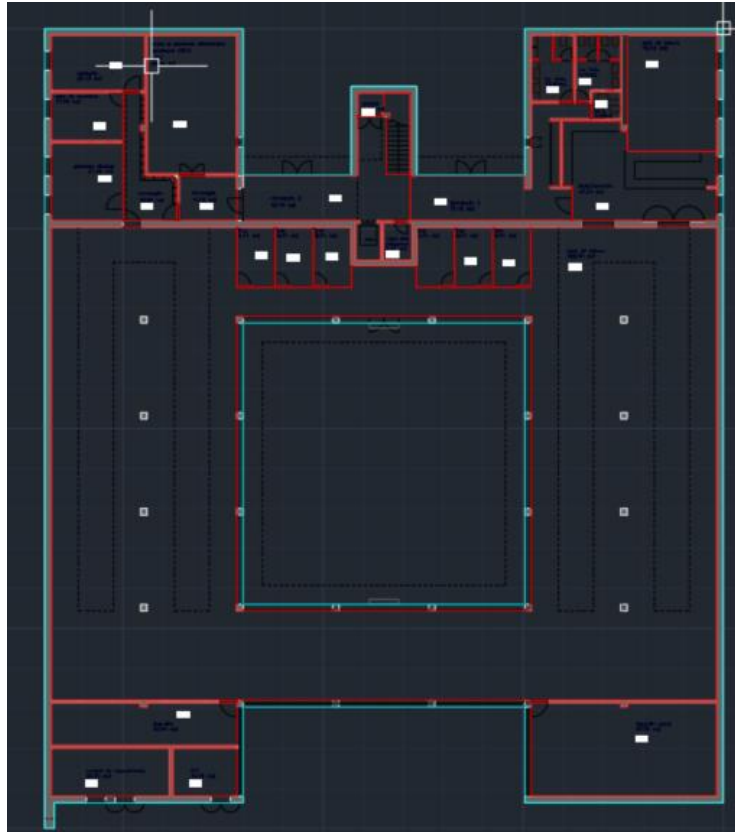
Planta do piso 0 do DEIS (AutoCAD, 2024).
